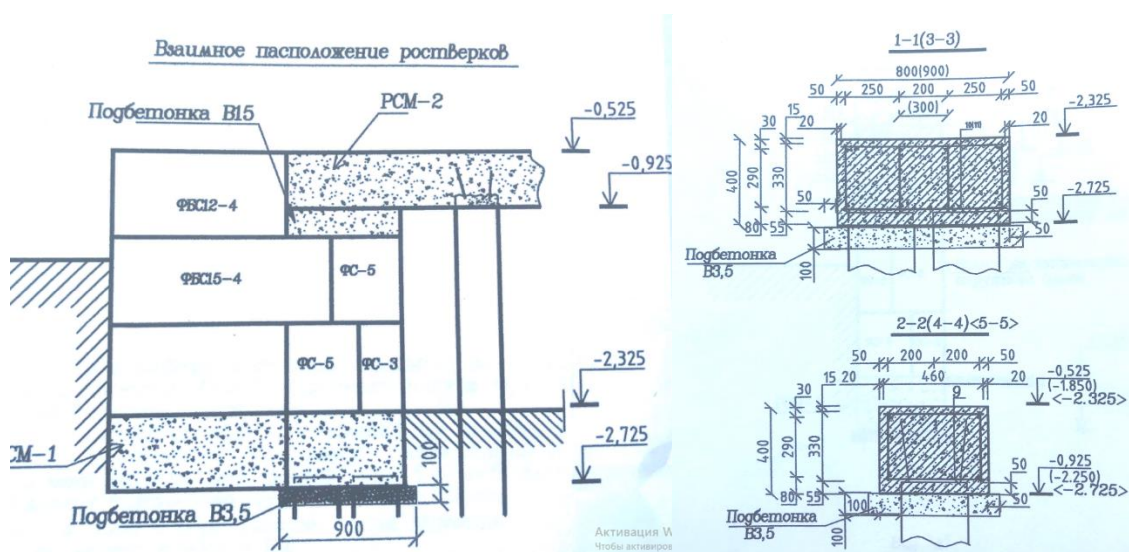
Разрезы по продольной оси по стене лоджии и ростверков.
